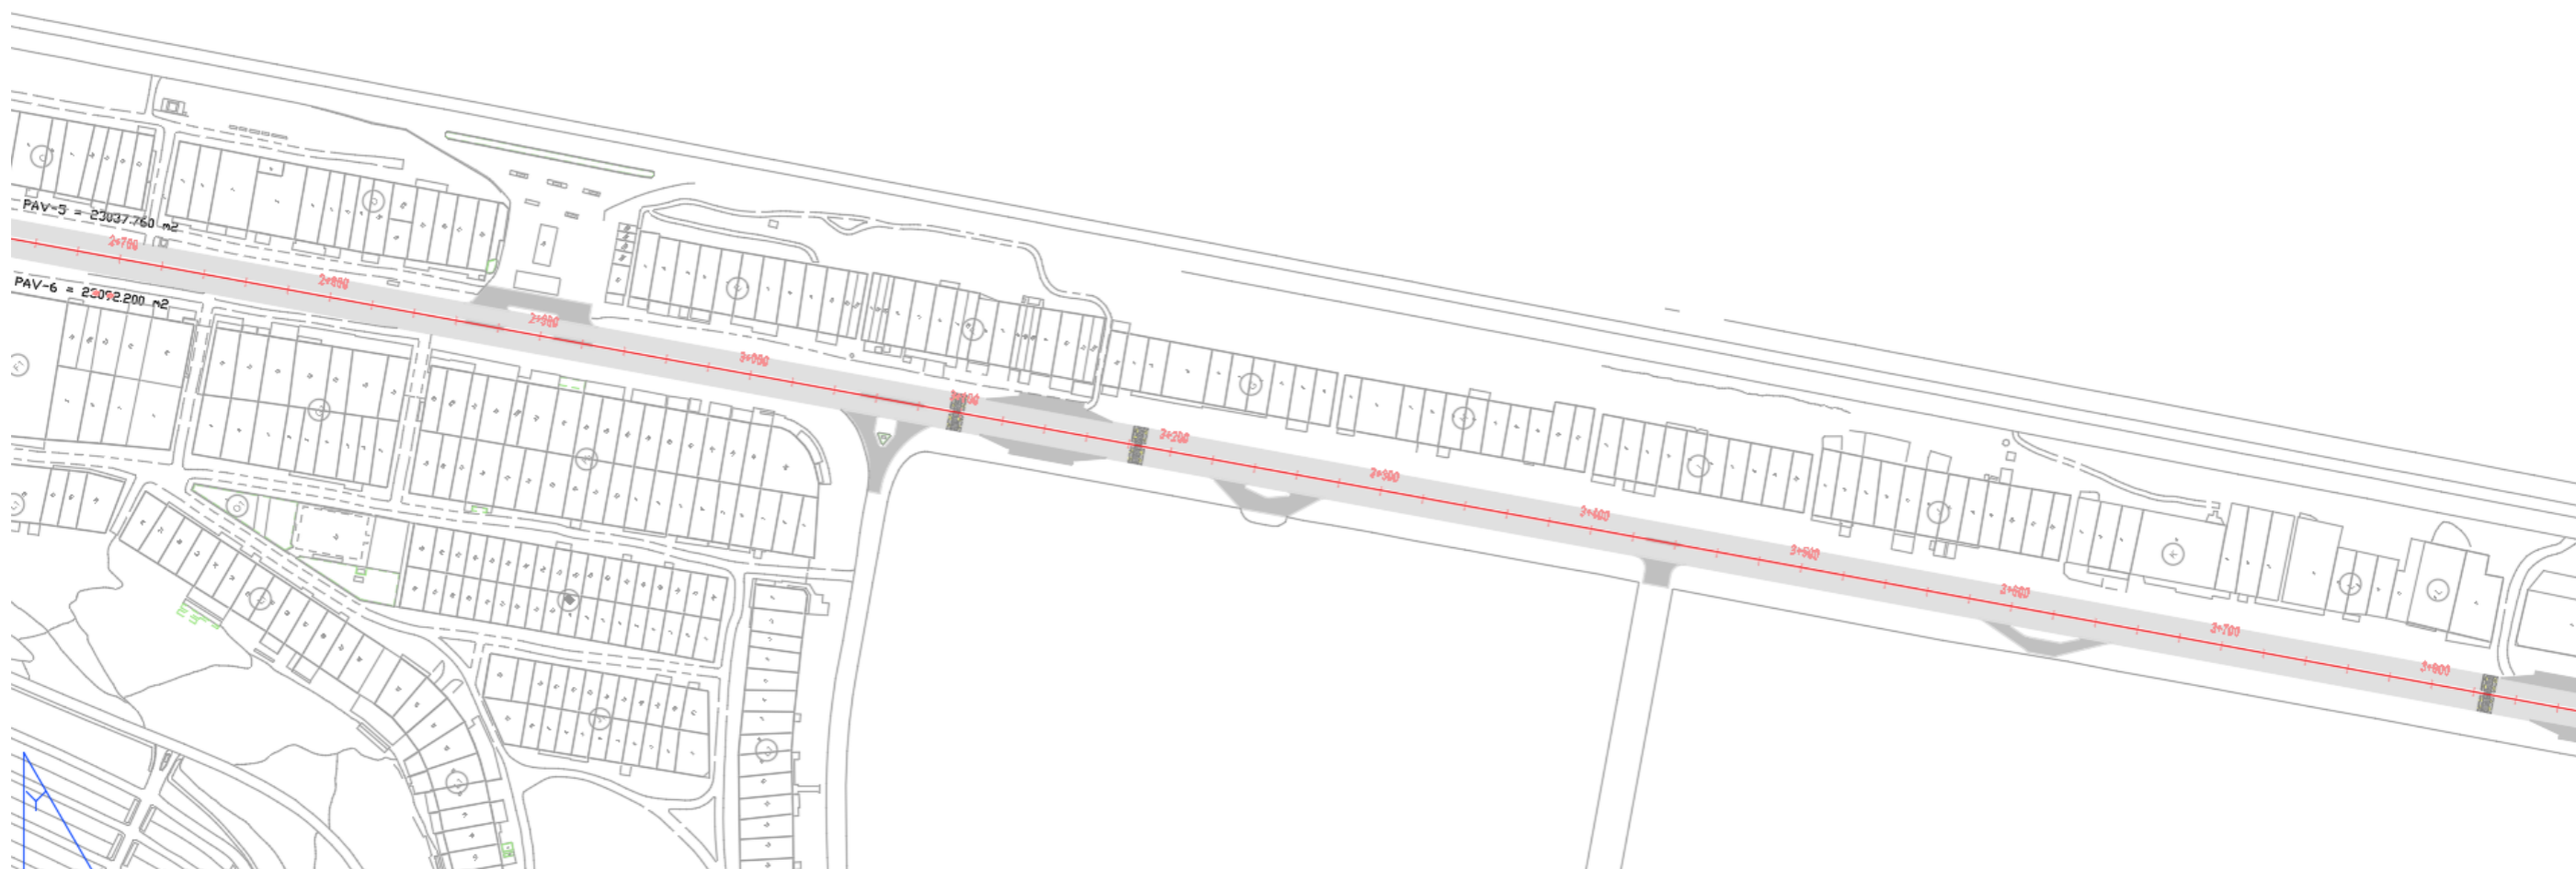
Plano Construcción Vía entre las Progresivas 0+000 al 1+400
